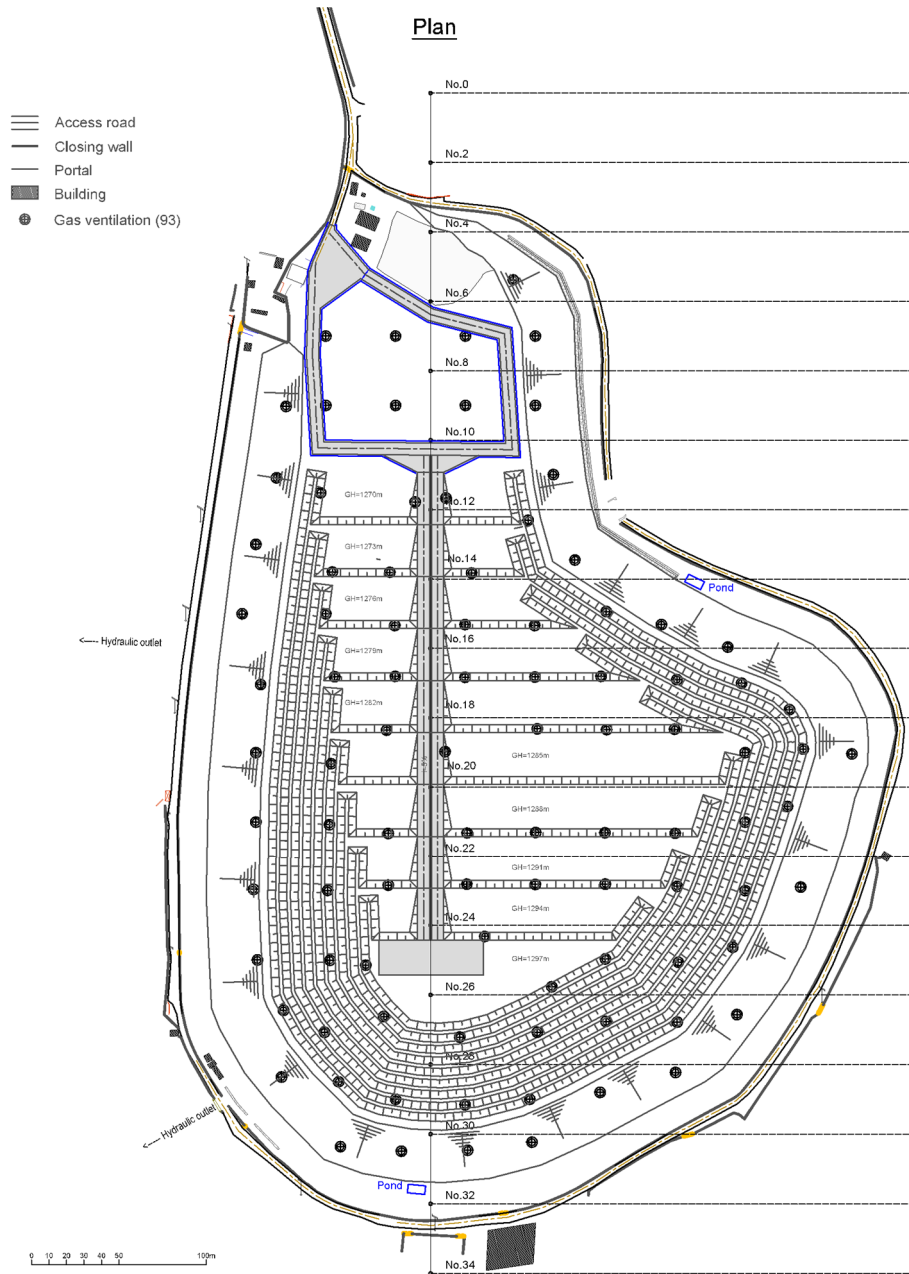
Plan de gestion du site d'enfouissement (Stade final)
